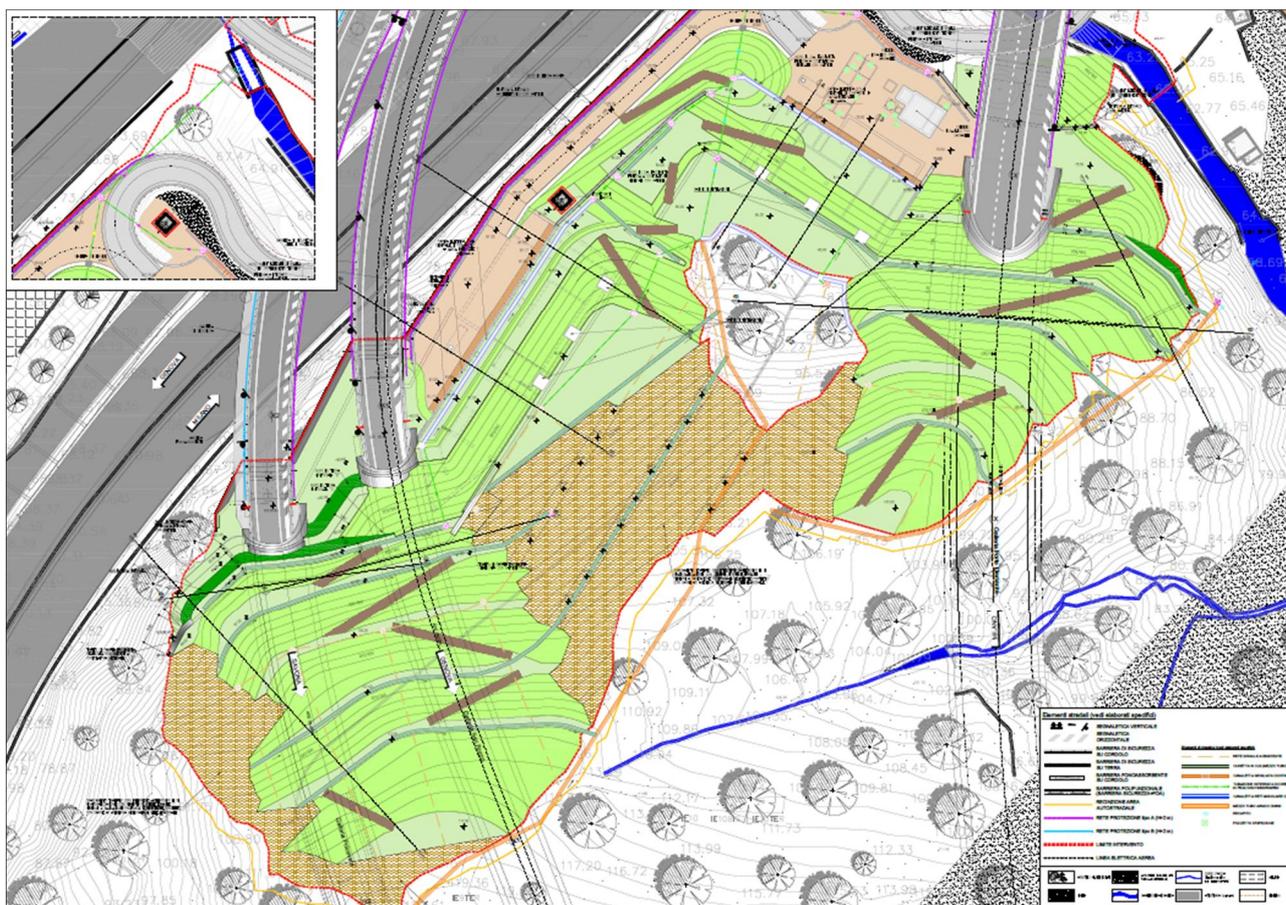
Planimetria dell'area d'imbocco ((fonte: elaborato 110722-LL02-PE-A2-G11-GF11N-SSF00-D-AUA0522-1)
